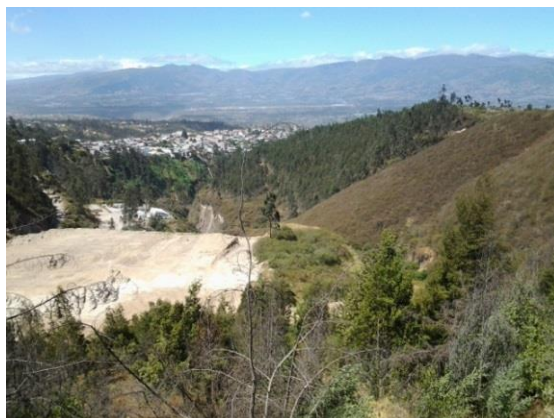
Vista de la zona lado. Escombrera Zábiza.
